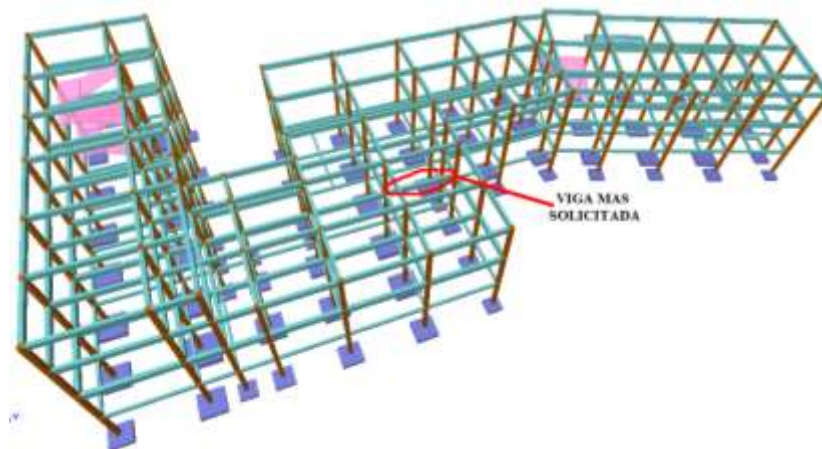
Viga más solicitada entre columnas C36 – C43 (fuente: CYPECAD 2014)
